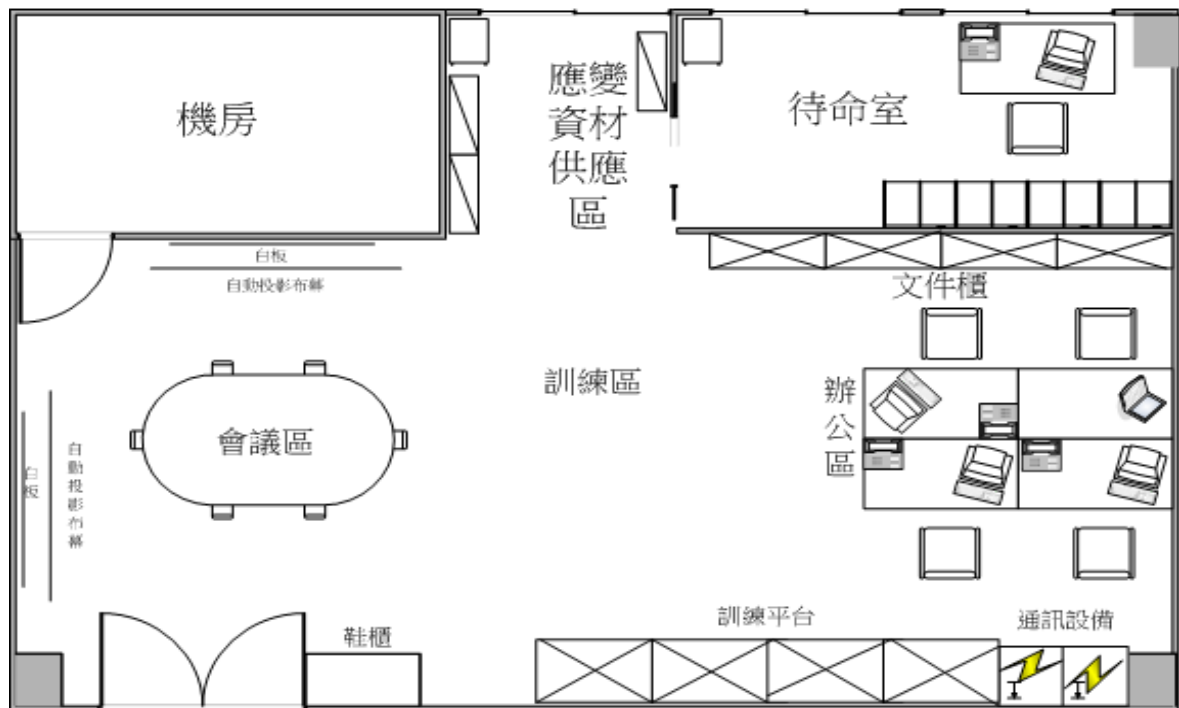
宜蘭隊內部配置平面圖(示意圖)
